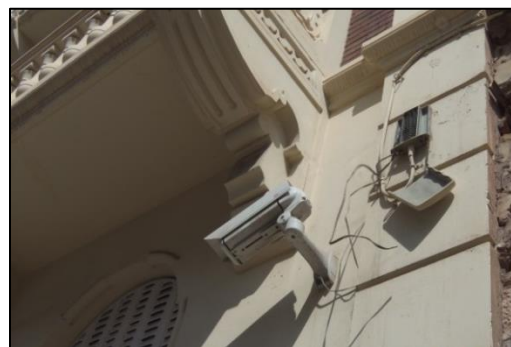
Cableado, cámara de vigilancia y caja de telefonía abierta.
